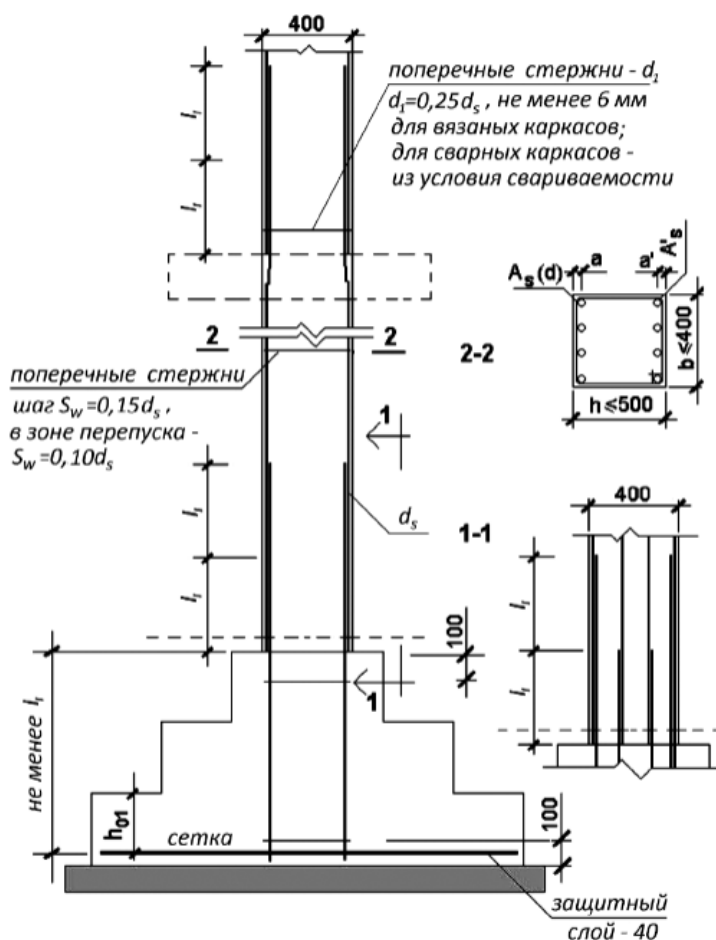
Схема армирования монолитной колонны многоэтажного здания
